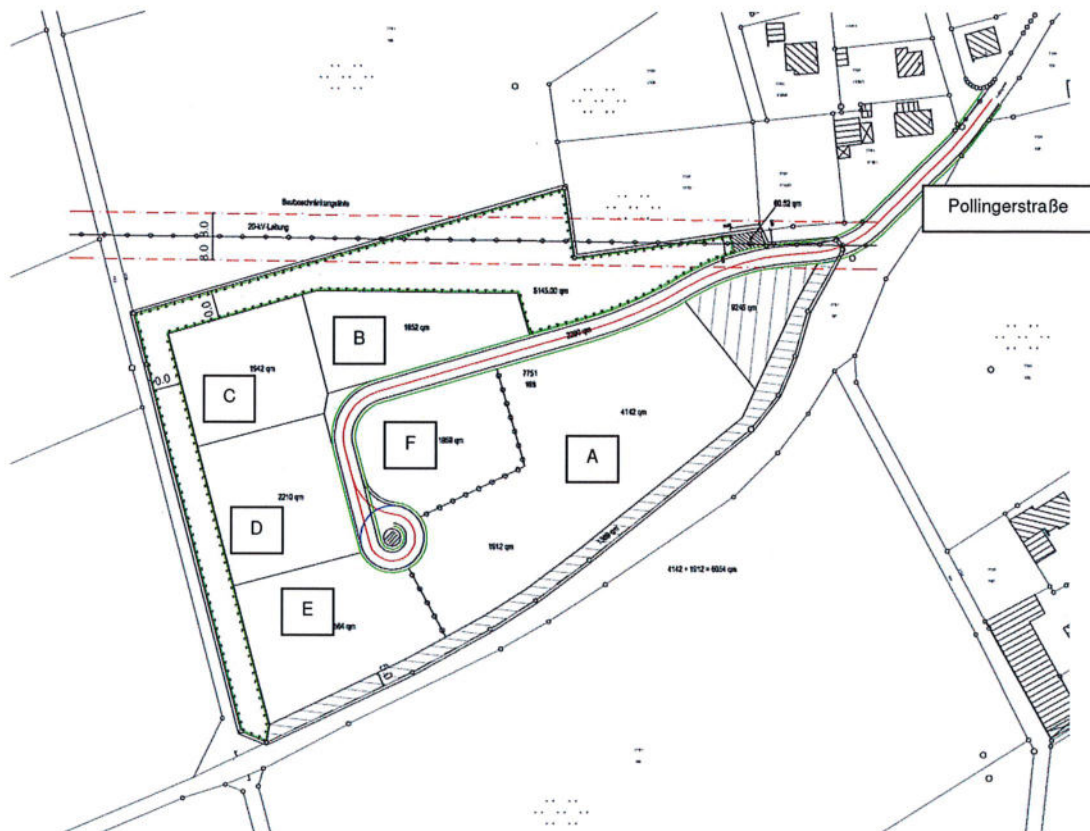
Ausschnitt Planteil des Bebauungsplanes für das geplante Gewerbegebiet „Eppishausen Süd-West“ (mit Darstellung Unterteilung in Teilflächen), Planstand 12.09.2013 [Quelle: IB Vogg, Großaitingen]
